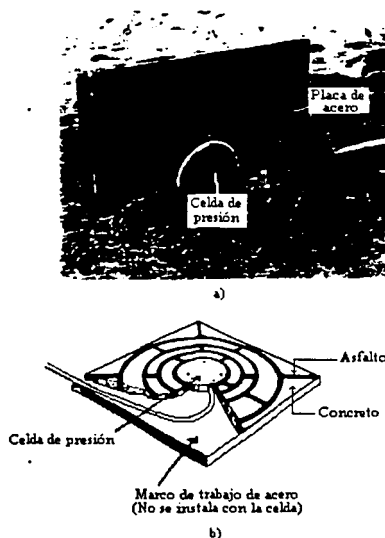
Celda de presión tipo diafragma montada: a) en una placa de acero, y b) en una placa segmentada de concreto.
